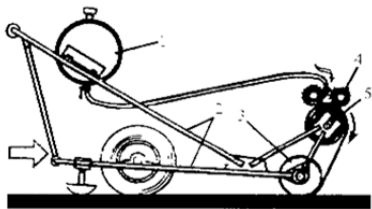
Установка для наклеивания наплавляемого рубероида безогневым способом: 1-бачок; 2-рама; 3-каток; 4- валики для смачивания 5-рулон
